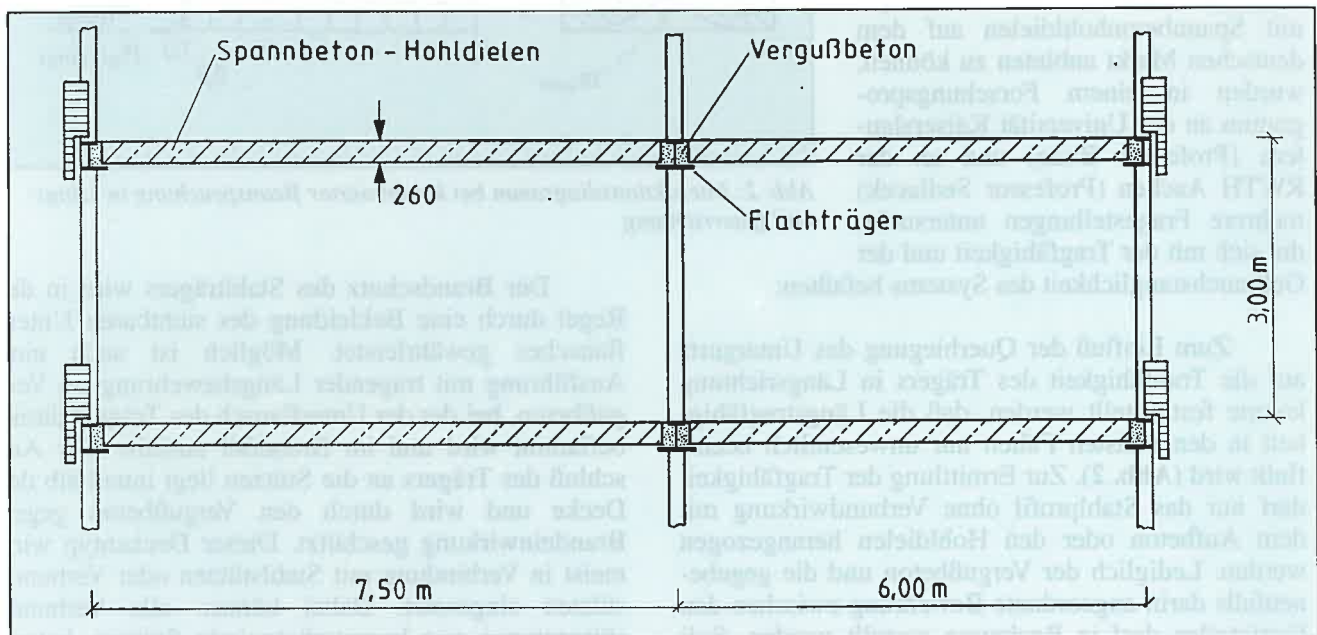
Technologie-Park Bergisch Gladbach, Haus 50/51: Querschnitt der Bürogeschosse mit Flachdecken
